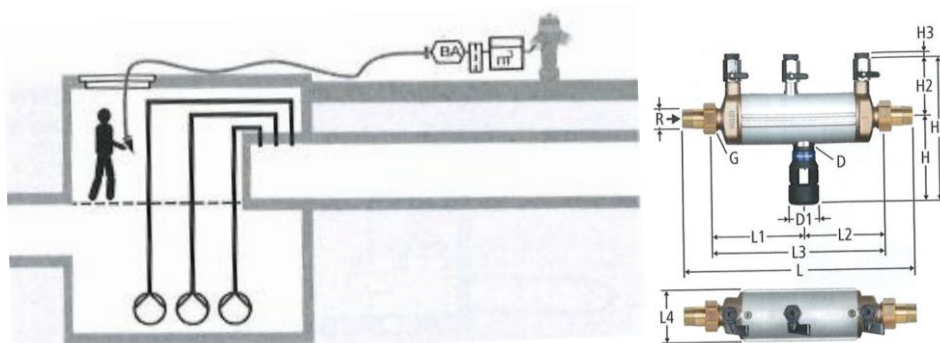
Anschlussschema Schlauch und Beispiel Systemtrenner
